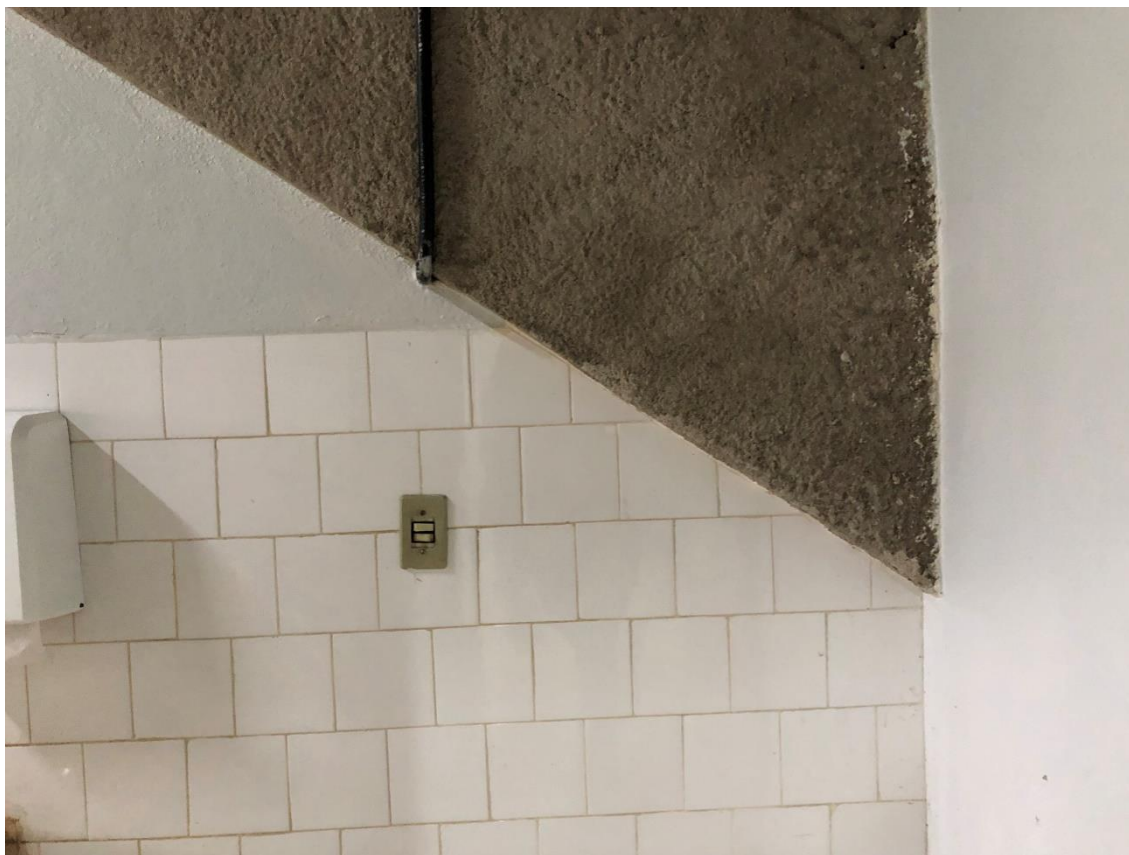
Revestimento existente, será removido para ser aplicado um novo e rebocar as vigas estruturais do ginásio.
